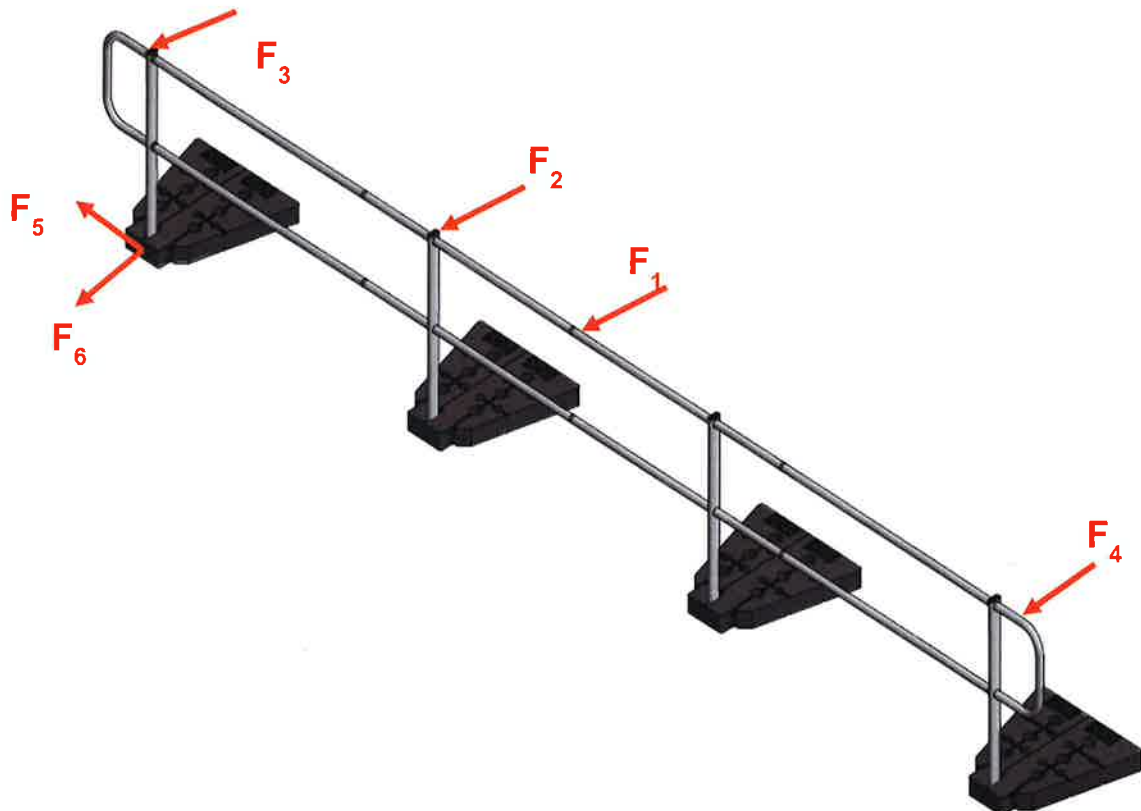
Prüfaufbau 4 mit den Richtungen und den Positionen der Kräfteinleitungen
